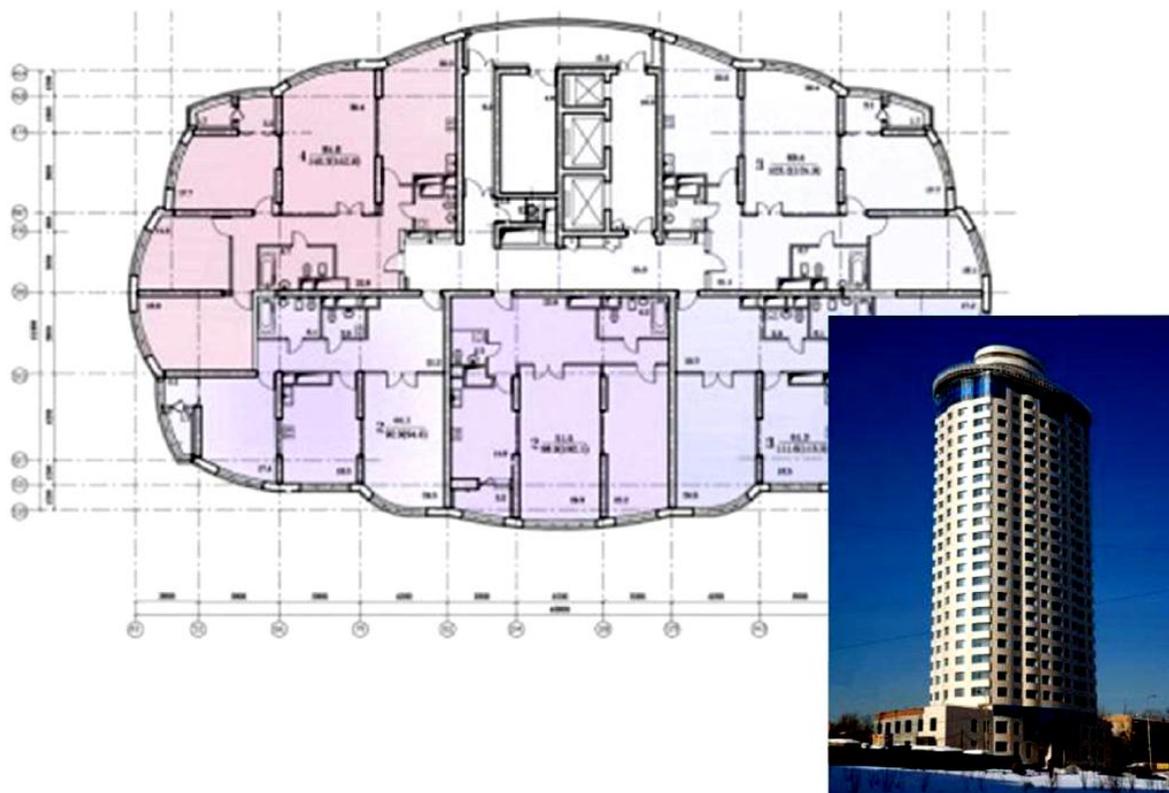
План 25-этажного жилого дома с монолитным каркасом в виде пилонов и стен
